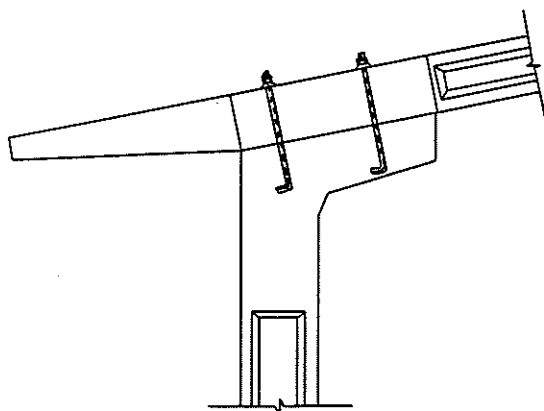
Ligação viga-pilar executada através de consolo e chumbador.
